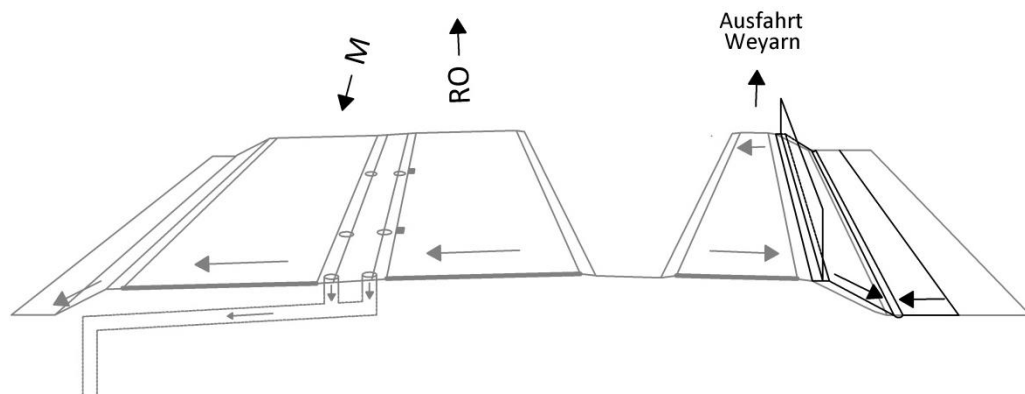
Entwässerungsschema – Weyarn-West (Anschlussstelle Weyarn)
